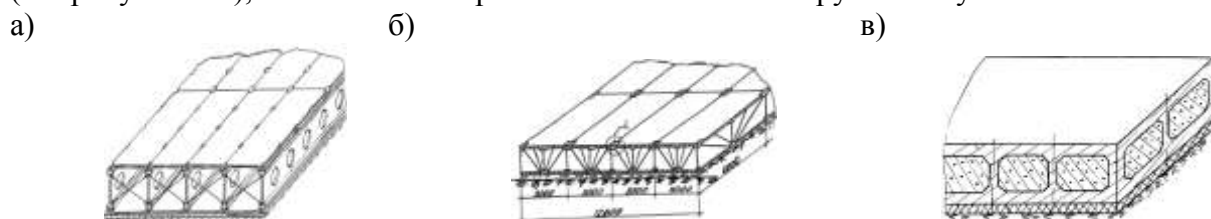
ПФП для строительства на слабых и вечномёрзлых грунтах: а) сборная железобетонная фундаментная платформа (патент № 2206665); б) сборная сталежелезобетонная фундаментная платформа (патент № 38789); в) монолитная фундаментная платформа (патент №44510)
